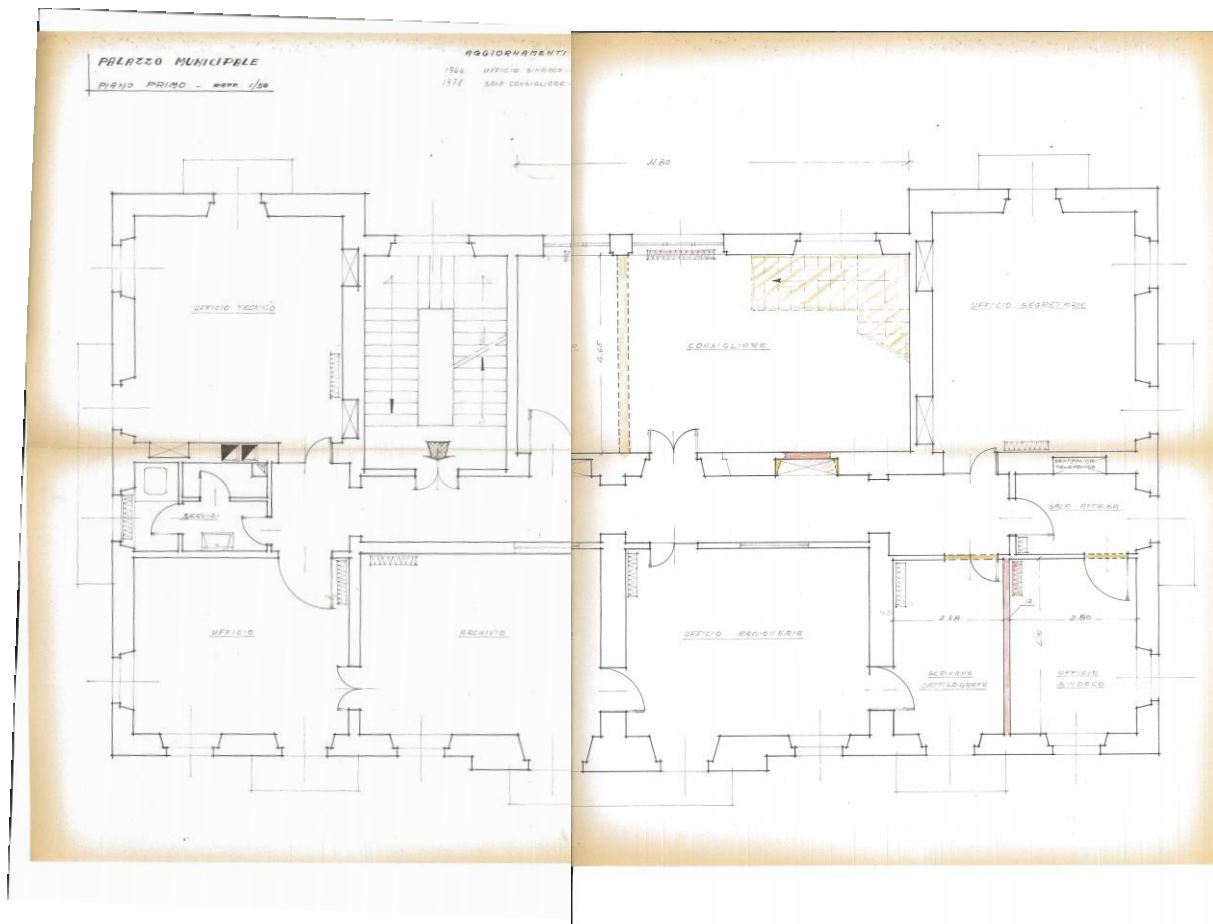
Pianta del piano Primo, con indicata la demolizione di una delle scale al piano primo e opere di diversa distribuzione degli spazi interni
